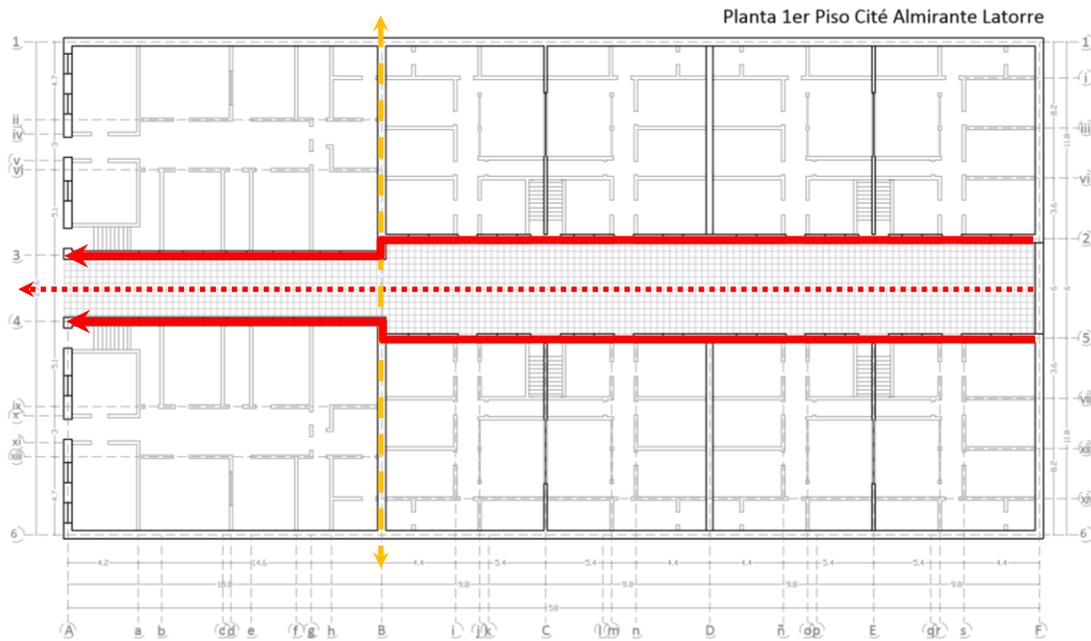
Planta intervenida donde se indica en color Naranja el eje donde los muros de fachada pierden su continuidad. Muros de fachada en color Rojo.
